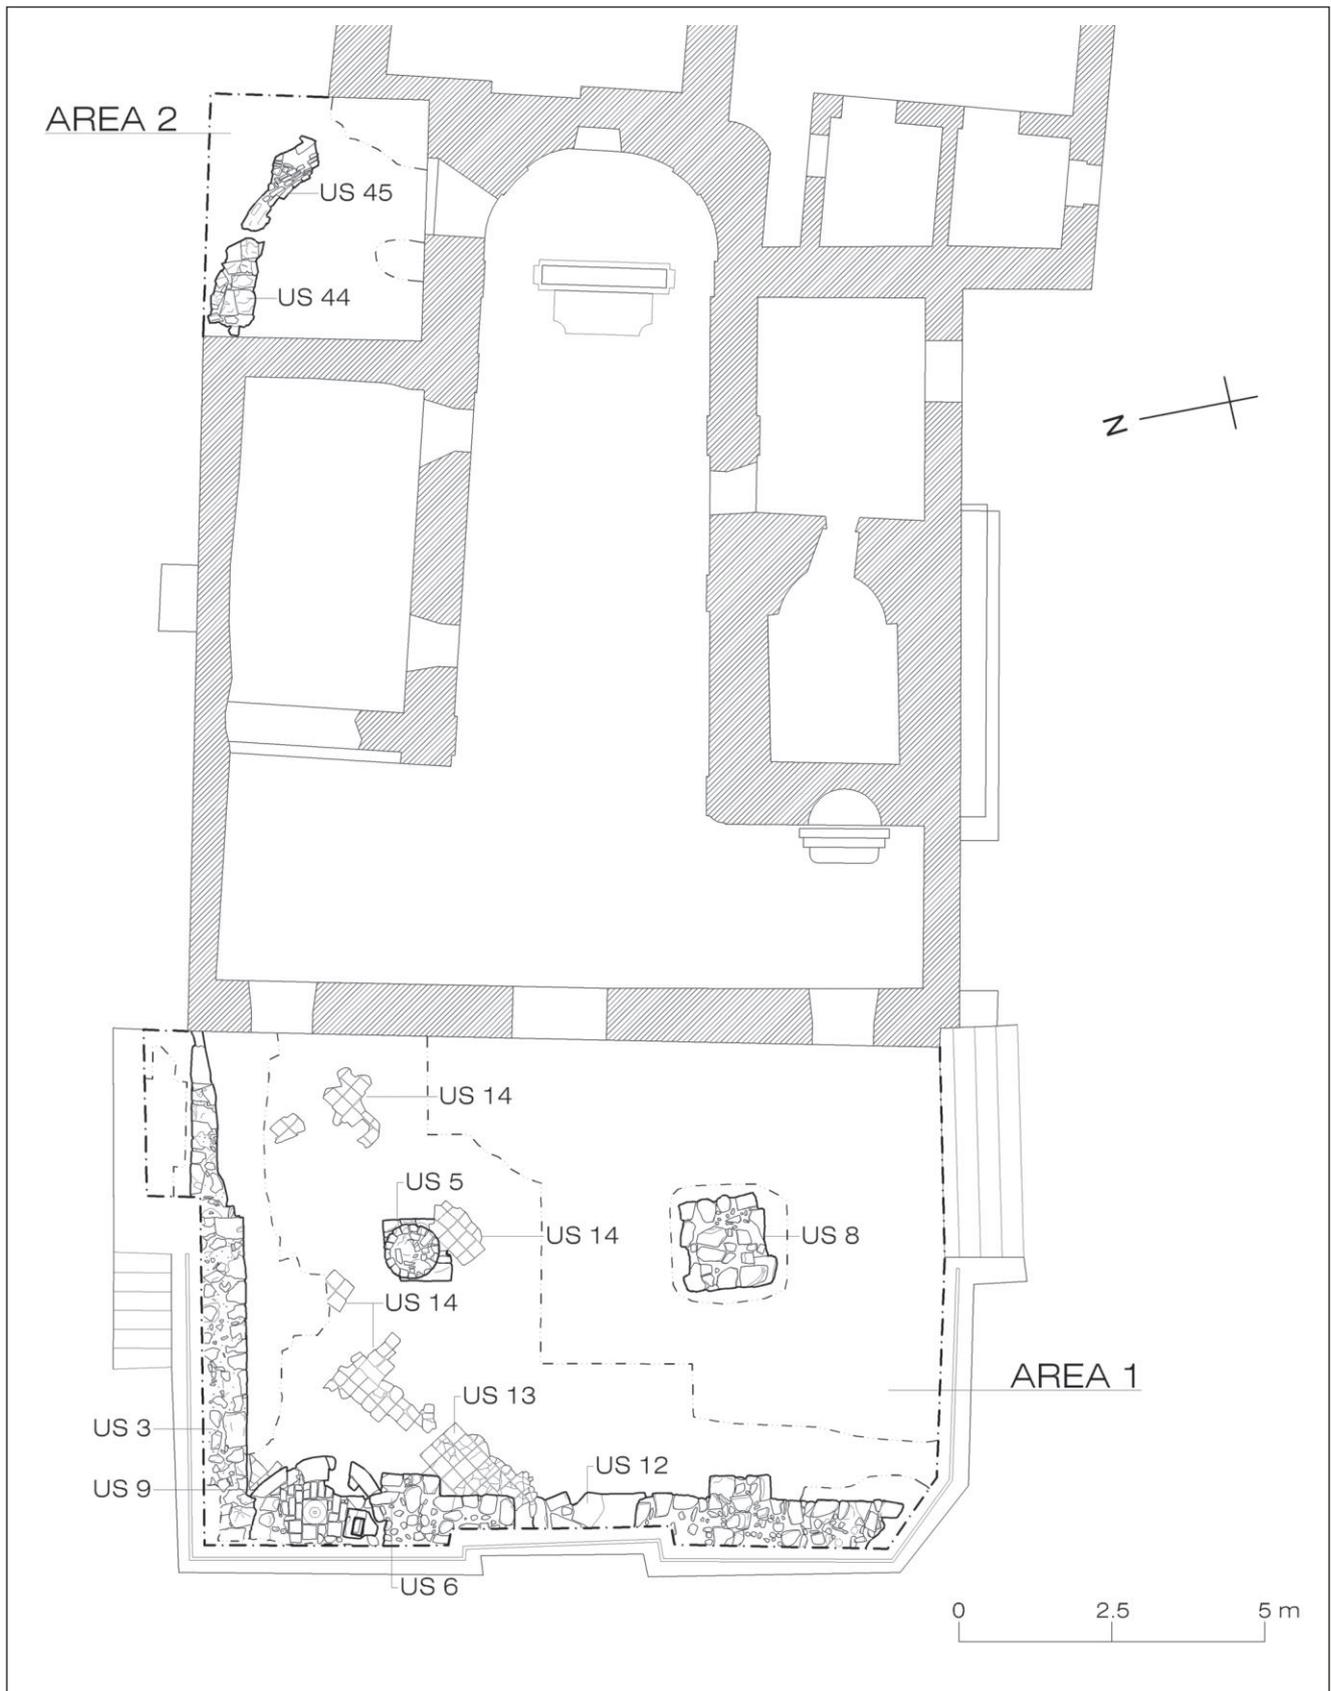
Ponti. Chiesa dell'Assunta Alta. Planimetria con le due aree indagate (ril. C. Cermelli - Lo Studio s.r.l.).
